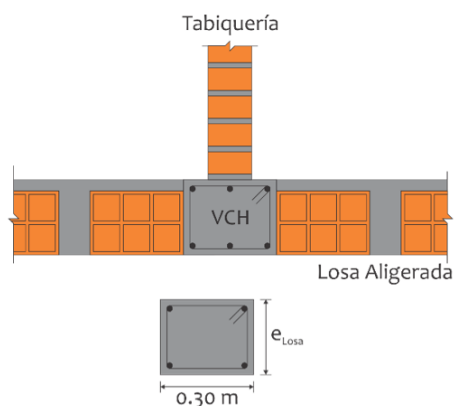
Corte en Elevación y Secciones de la Viga Chata.
